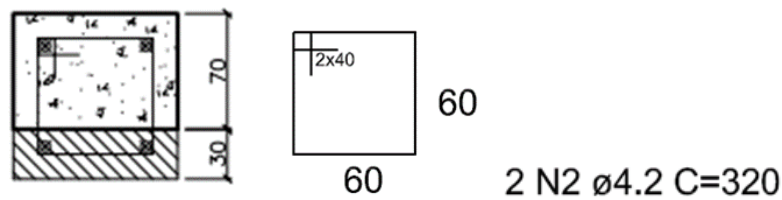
Detalhamento da armadura transversal utilizada nas vigas (dimensões em mm).
